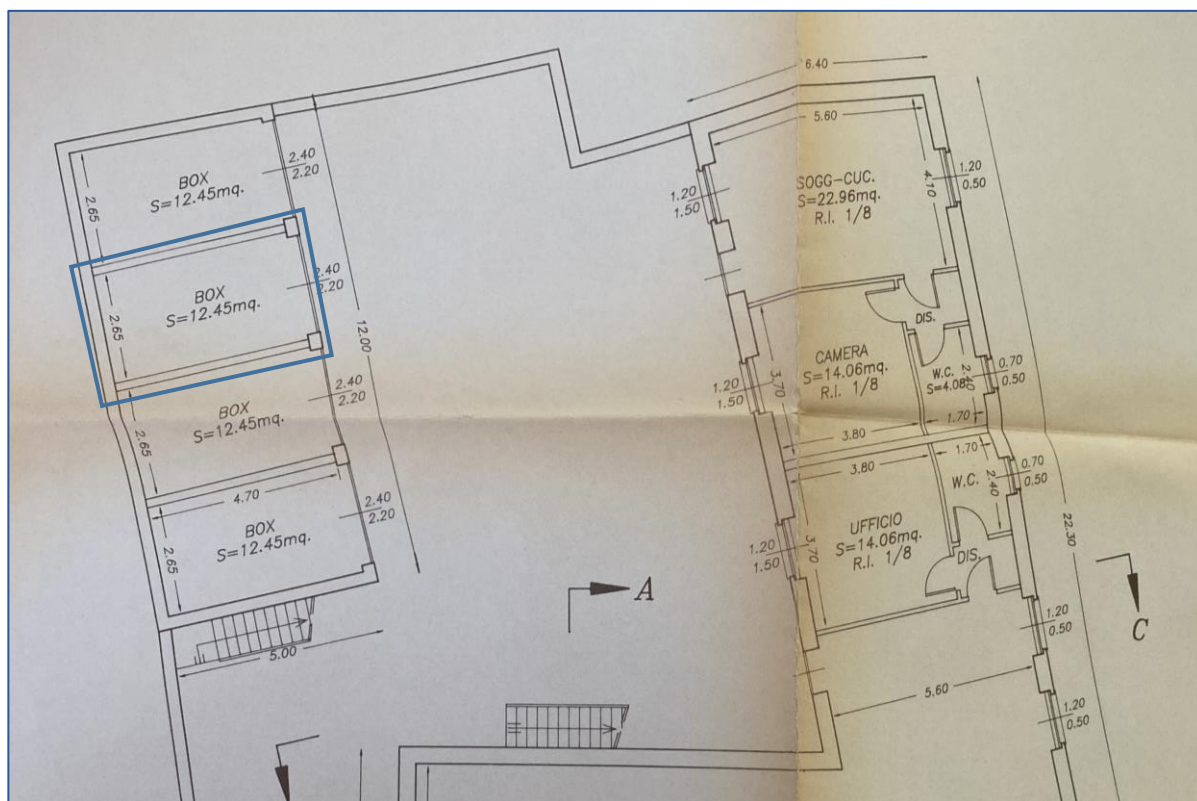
Estratto tavole di progetto P.E. 7/91 - Corpo B - Box
